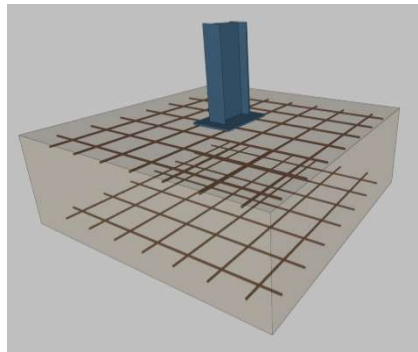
Vista 3D de la zapata tipo F. (Fuente CYPE 3D).
